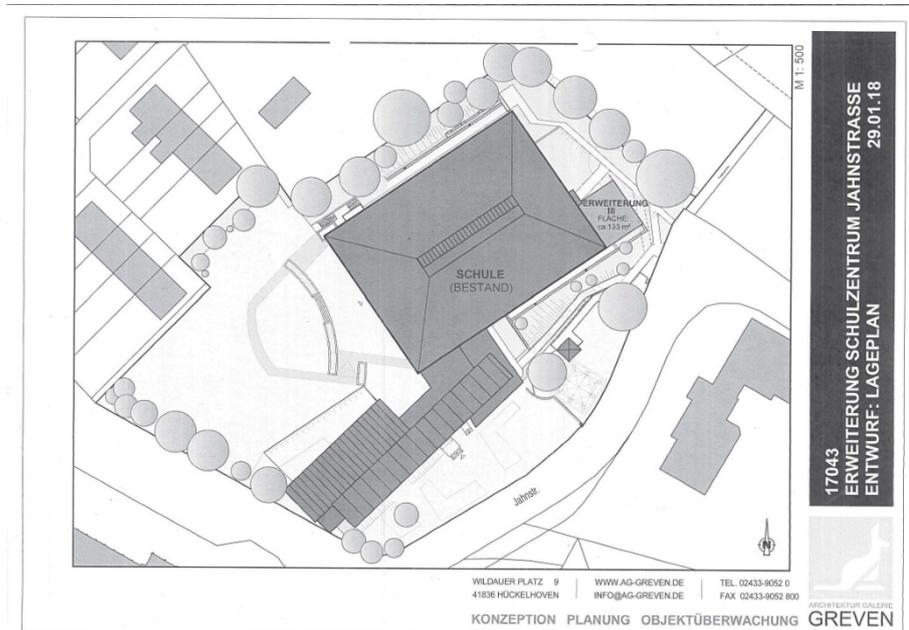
Planung Anbau Adam-Ries-Schule an der Jahnstraße (Quelle: Stadt Eschweiler)
